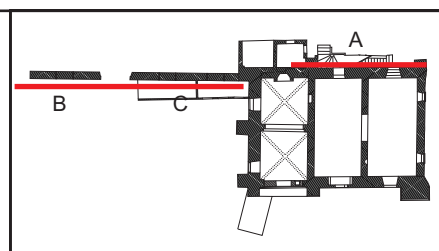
Fig. B et C : Façade sud de la nouvelle aile (mur 512)
